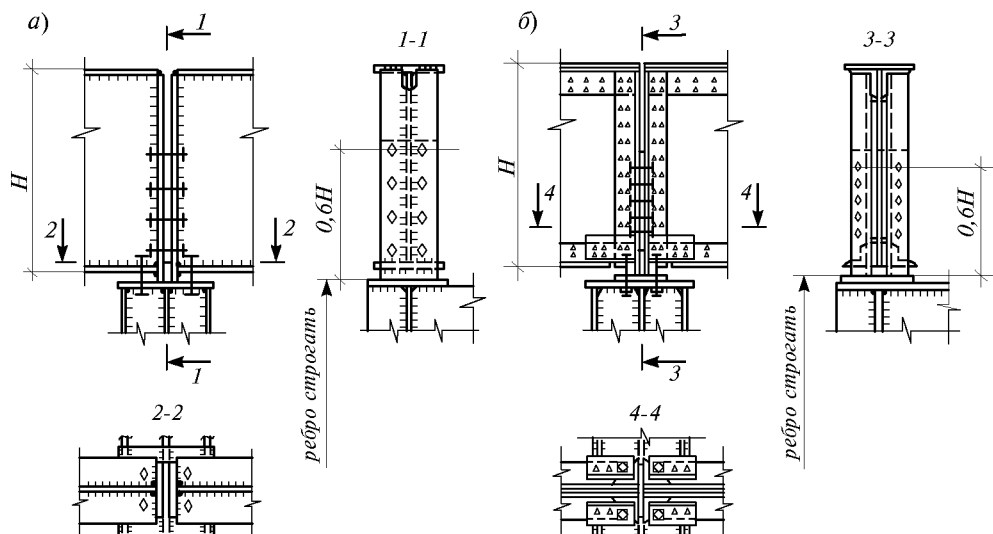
Опирание разрезных подкрановых балок на стальные колонны
